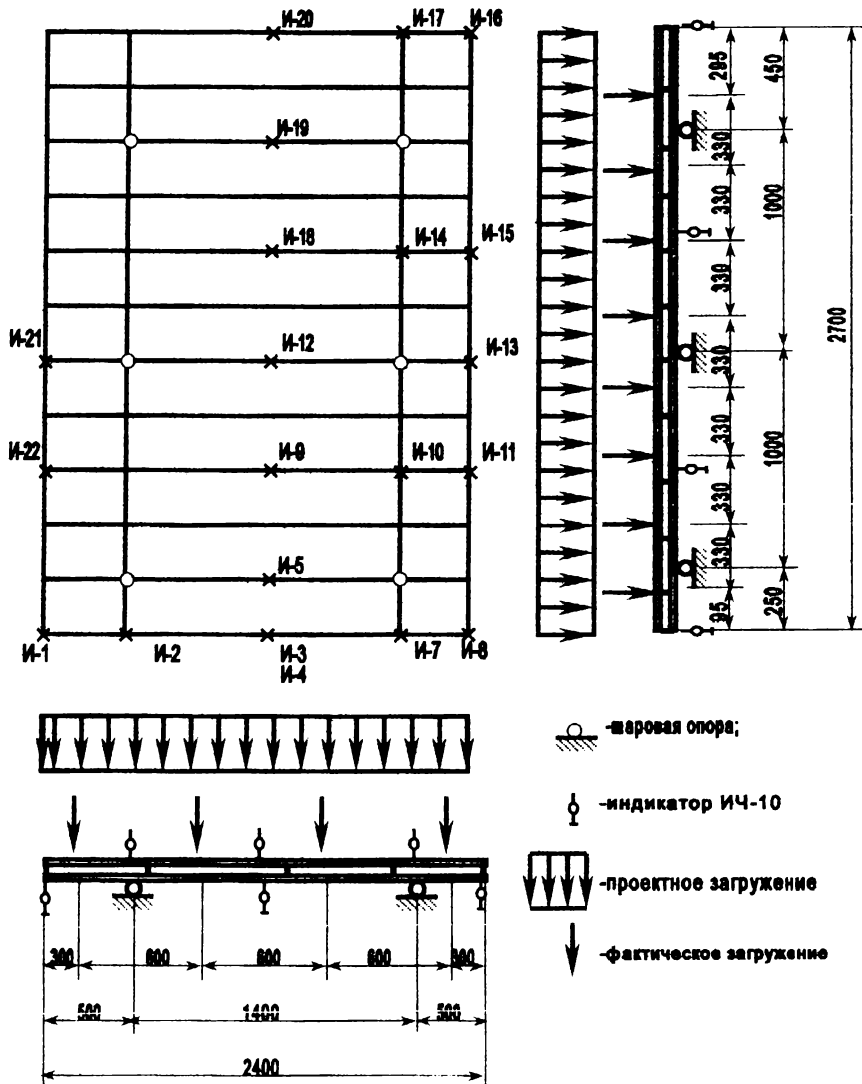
Схема испытания стального каркаса 2.7x2.4 м на изгиб
